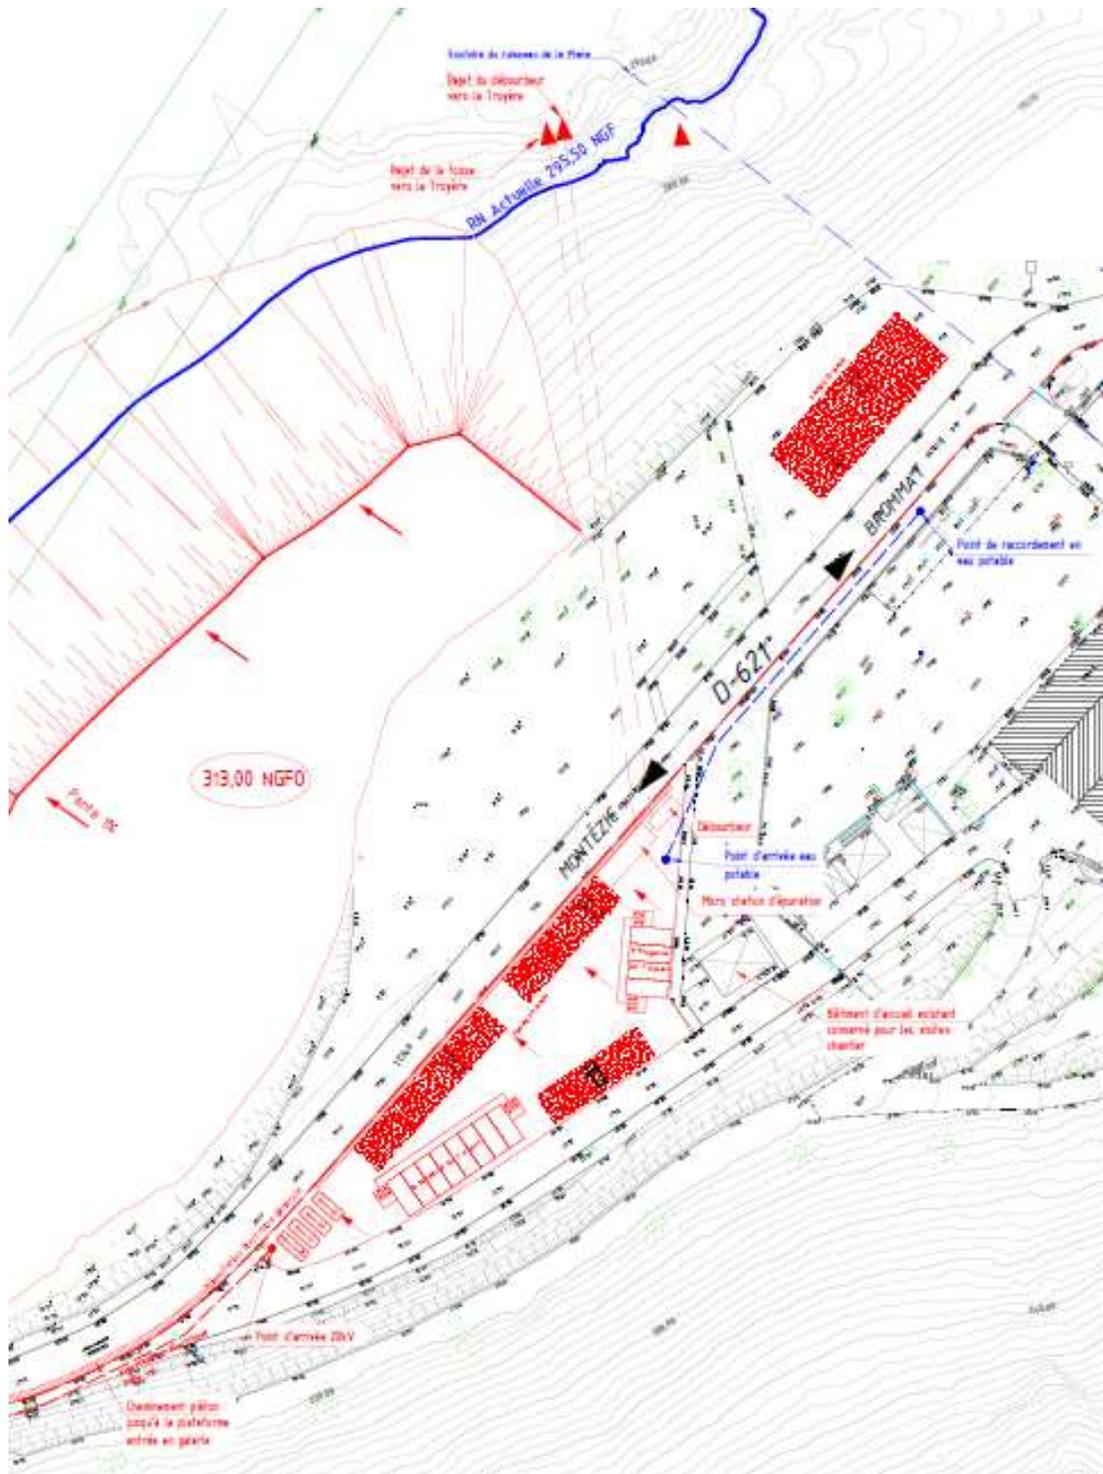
Plan base vie pour le lot Reconnaissances (parking en achuré rouge)
